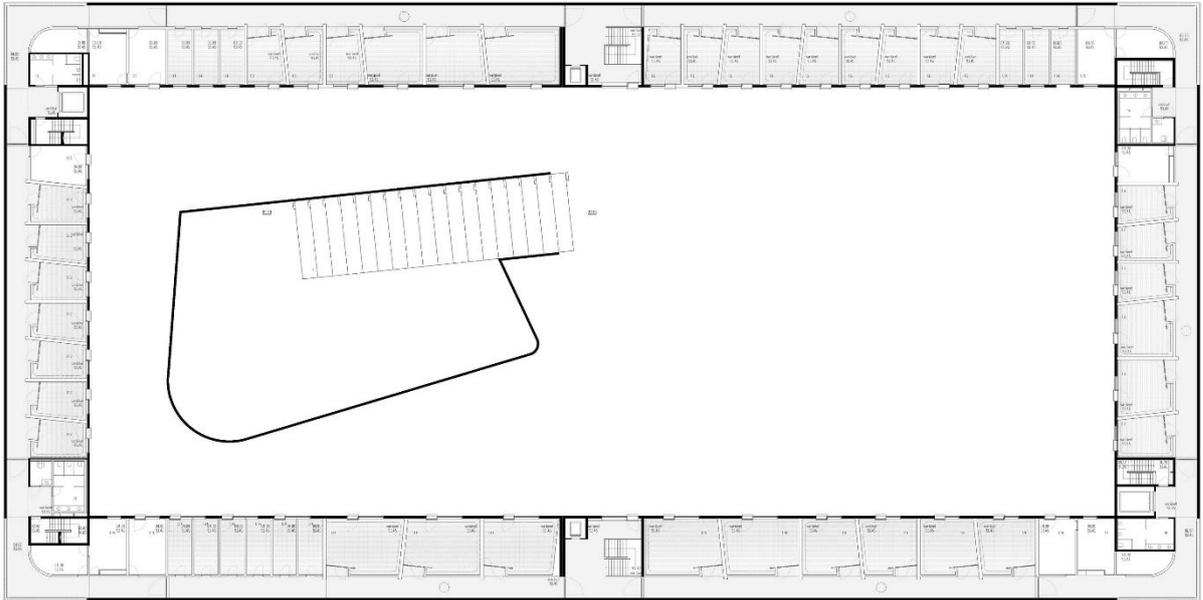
Planta do primeiro pavimento (FONTE: Open Buildings, 2013).
